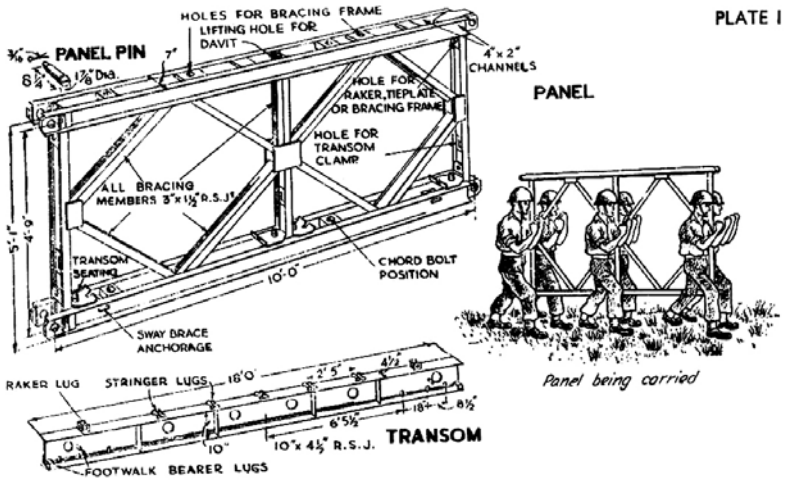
Il modulo principale del ponte Bailey e la sua movimentazione a spalla - *Bailey bridge field manual* - (Department of the Army, Washington DC, 1982)
